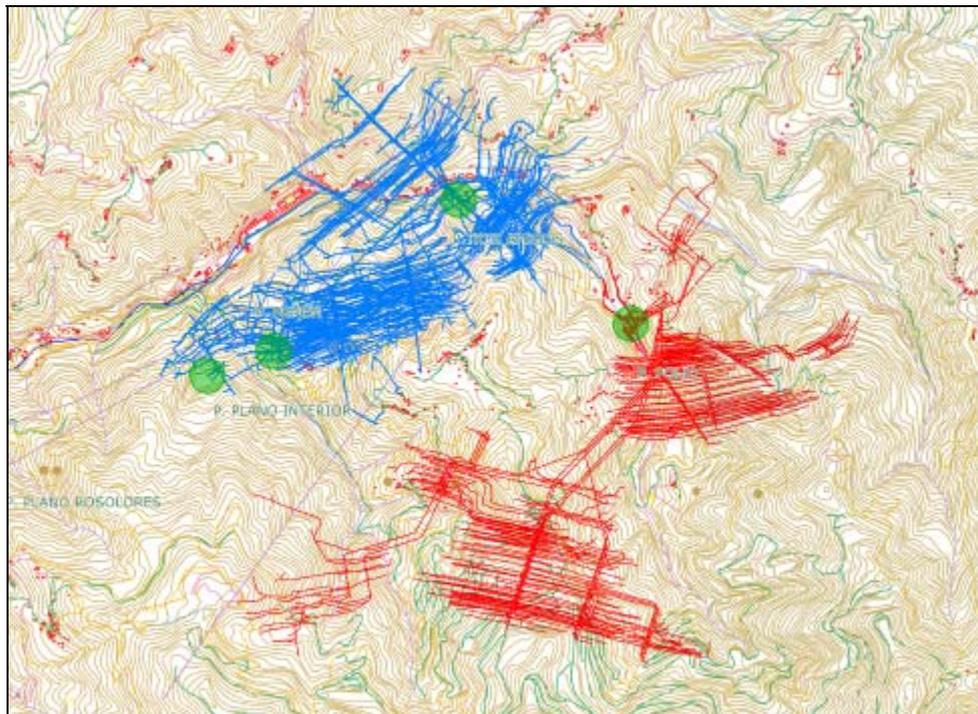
Plano de labores de los pozos Polio y Tres Amigos (en planta).
